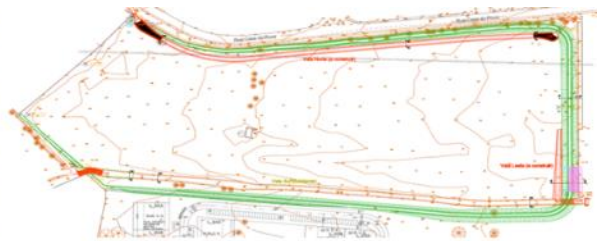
Localização do projeto – Bacia de Retenção a construir (Planta Geral)
